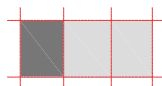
Construção em adobe, tufo ou tijolo (*Arquitectos 1961*)
